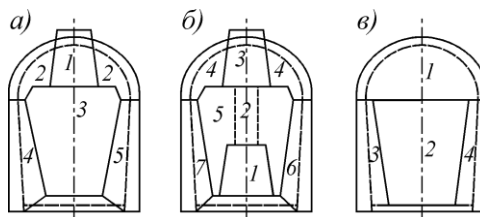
Послідовність розкриття виробітку методом опорного ядра: а) одноштовльнева схема; б) двоштовльнева схема; в) з випереджальною калоттою
